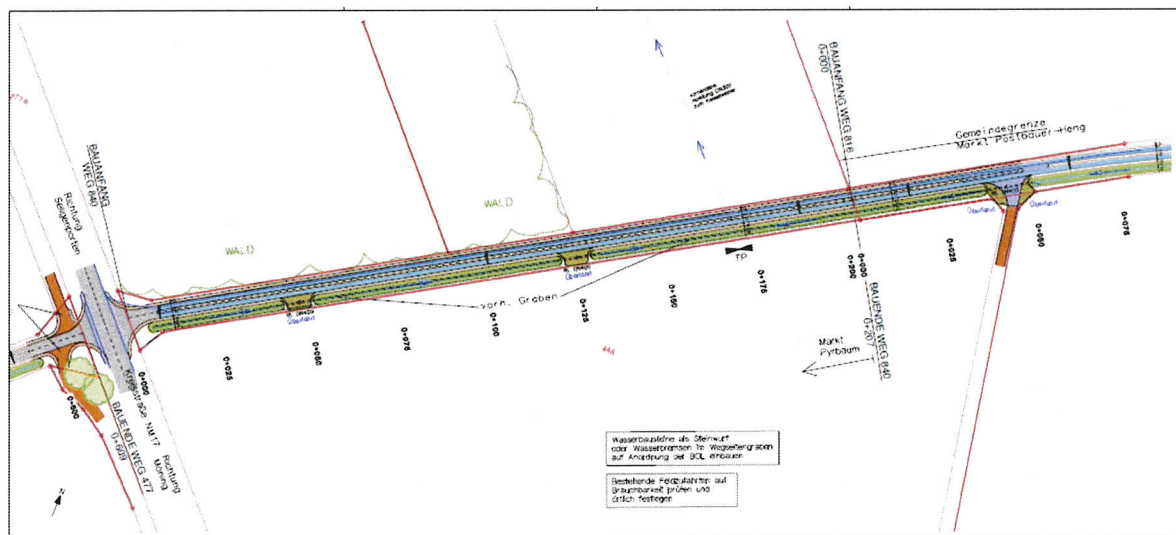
Planung der Straßenflächen (MKZ 116 441)
